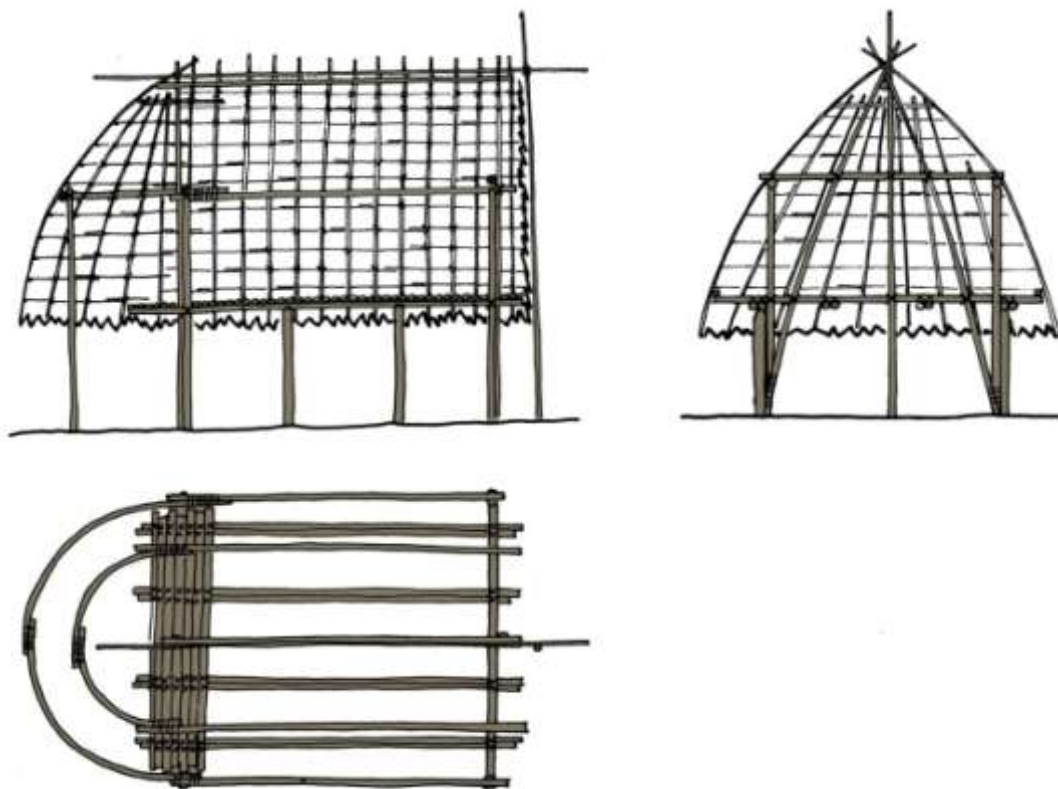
Estruturas das casas Wajãpi sobre palafitas
